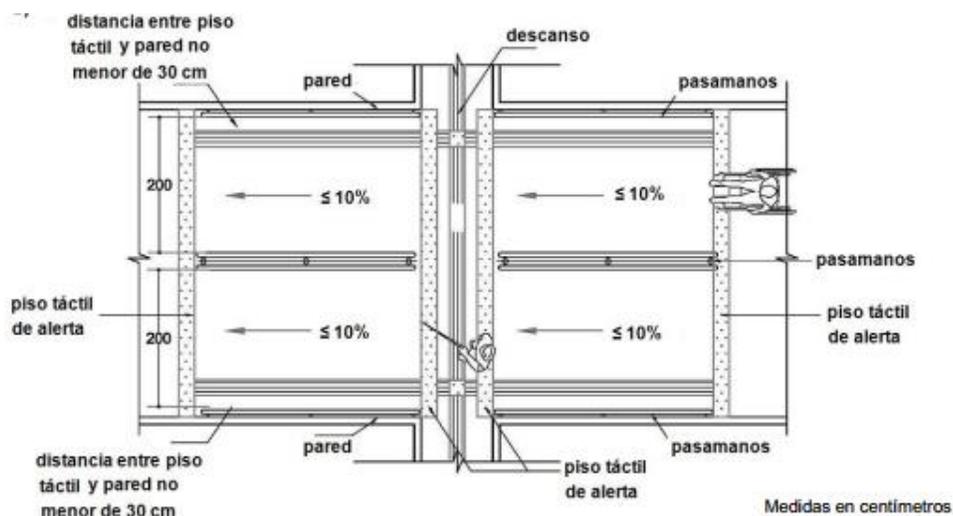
Vista en planta de rampa y de pasamanos central en donde se indica el espacio para el cambio de carril en cada descanso. Fuente CONAIPD
